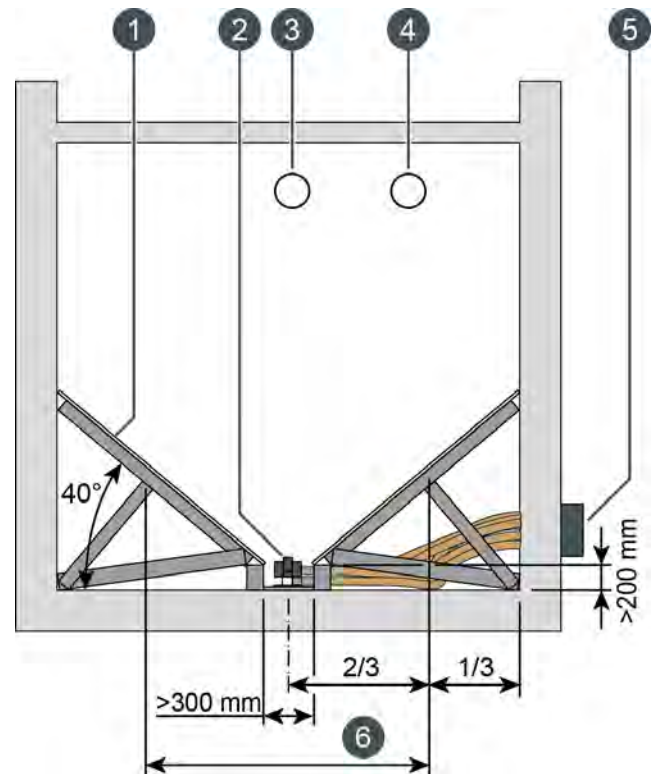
Construction du plancher incliné pour les sondes d'aspiration
